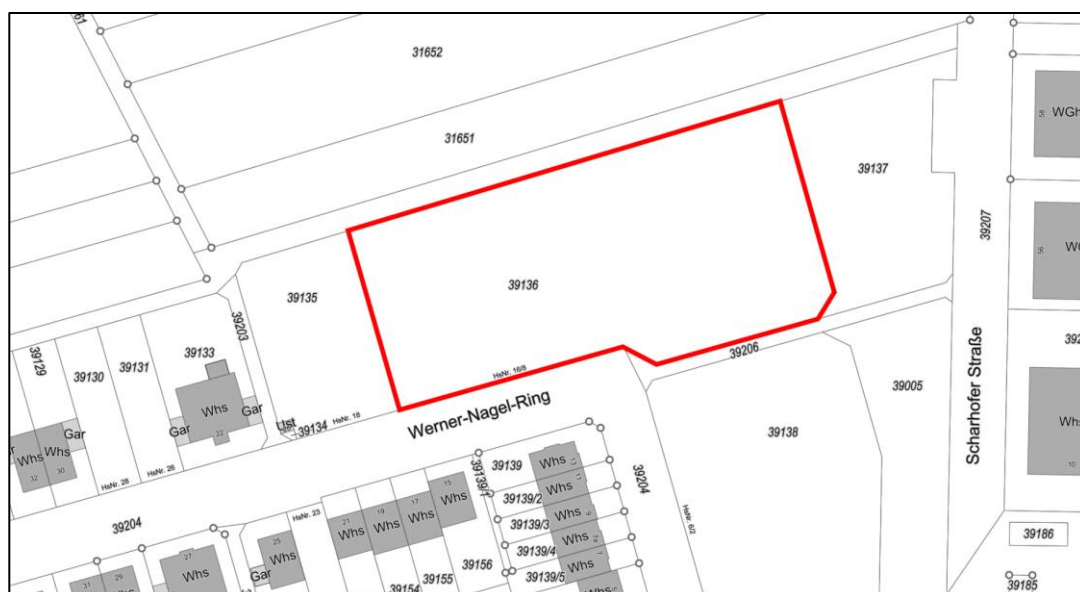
Lageplan mit Lage des Planungsgrundstücks (genordet, ohne Maßstab)
